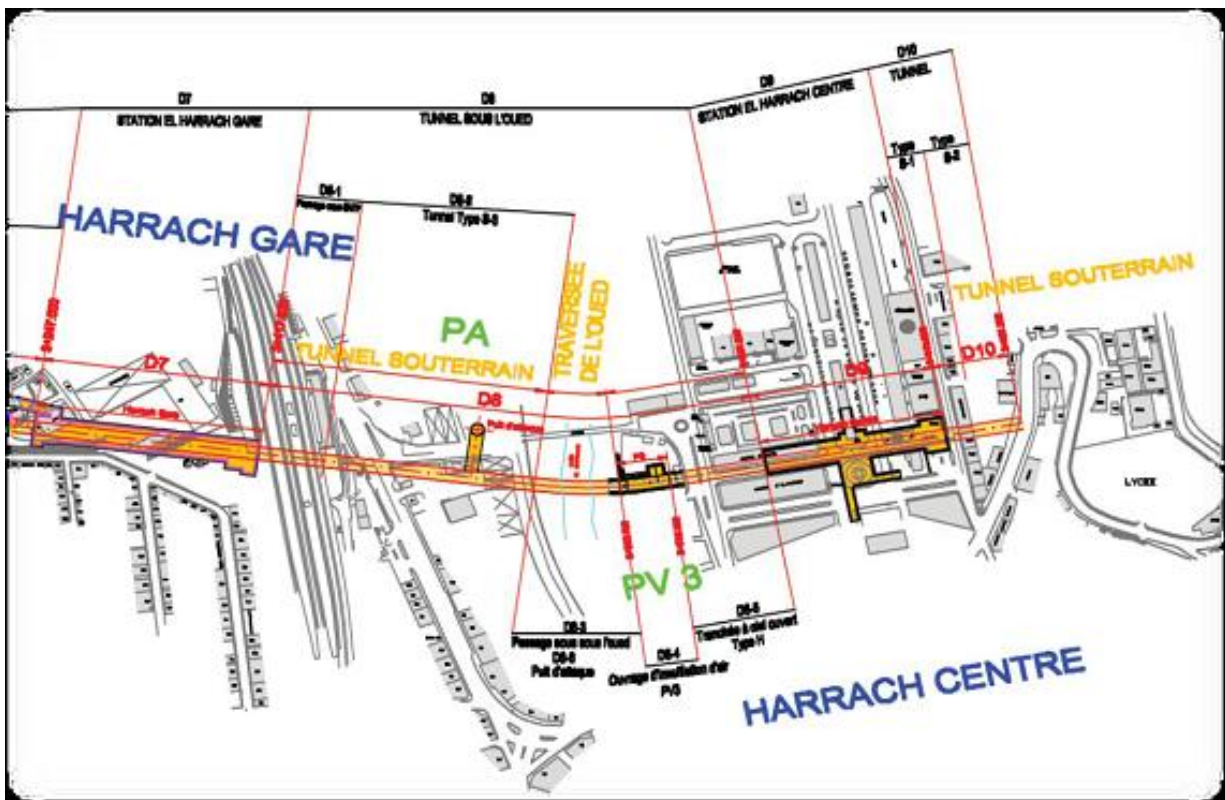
Plan d'implantation de l'ouvrage vue en plan. (Omrani K et Boutria H, 2012).
